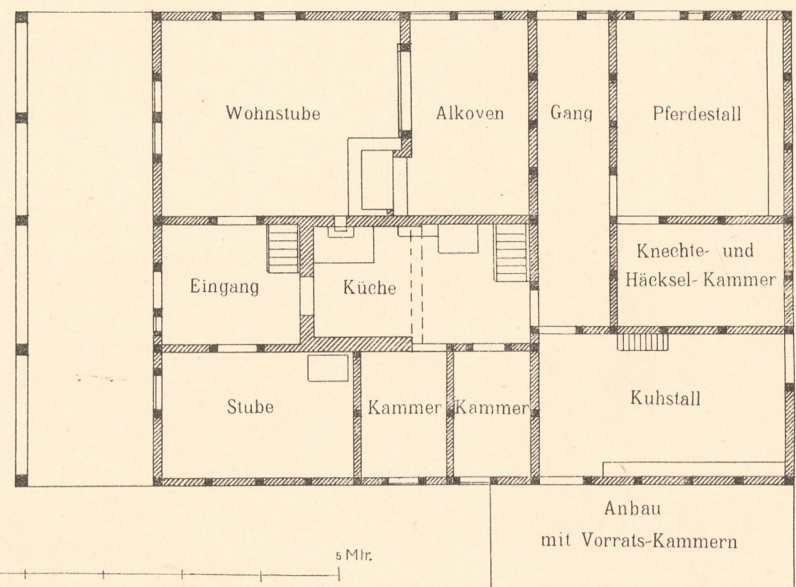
Zäckerick Grundriss vom Erdgeschoss.
